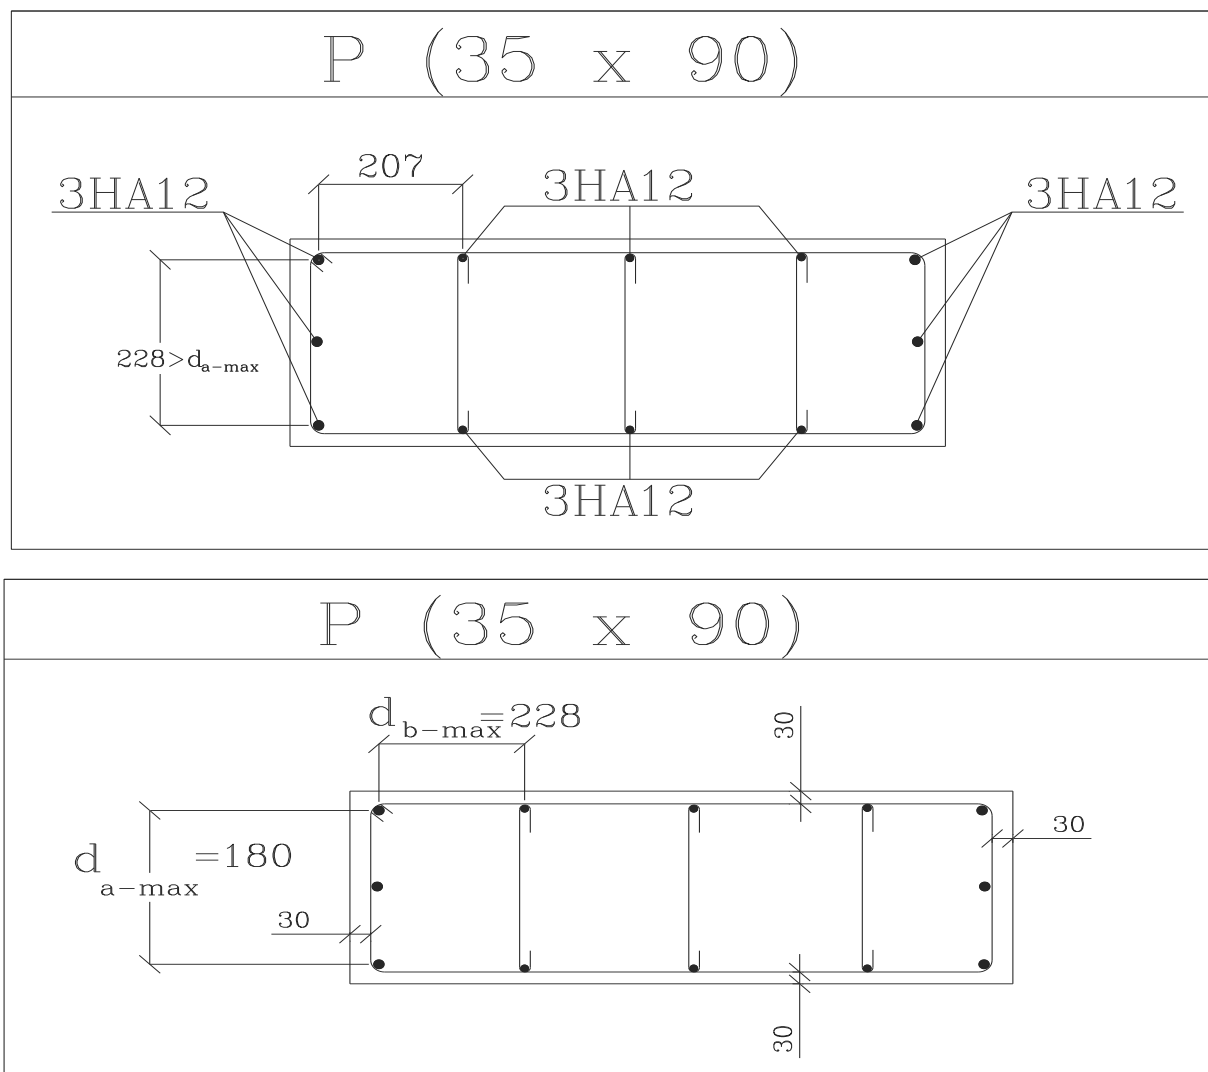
Schéma de ferrailage du poteau 35x90 à l'état minimal (Exemple 2)
